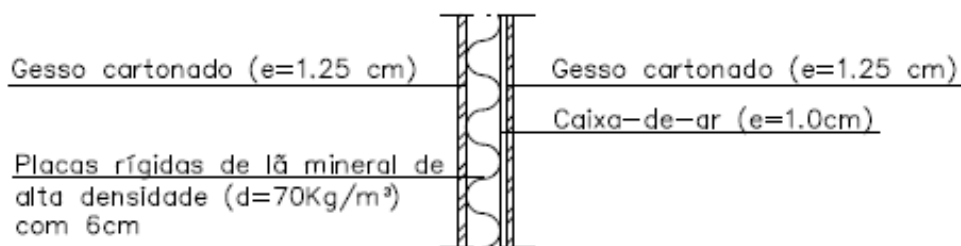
Pormenor construtivo da parede divisória interior (Projeto de Requisitos Acústicos)
